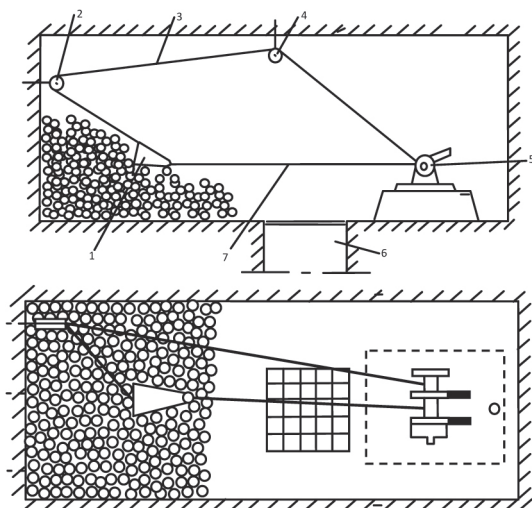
Схема роботи скреперної лебідки 30ЛС-2С: 1 – скрепер; 2 – опорний блочок; 3 – неробочий канат; 4 – підвісний блочок; 5 – скреперна лебідка; 6 – рудоспуск; 7 – робочий канат
